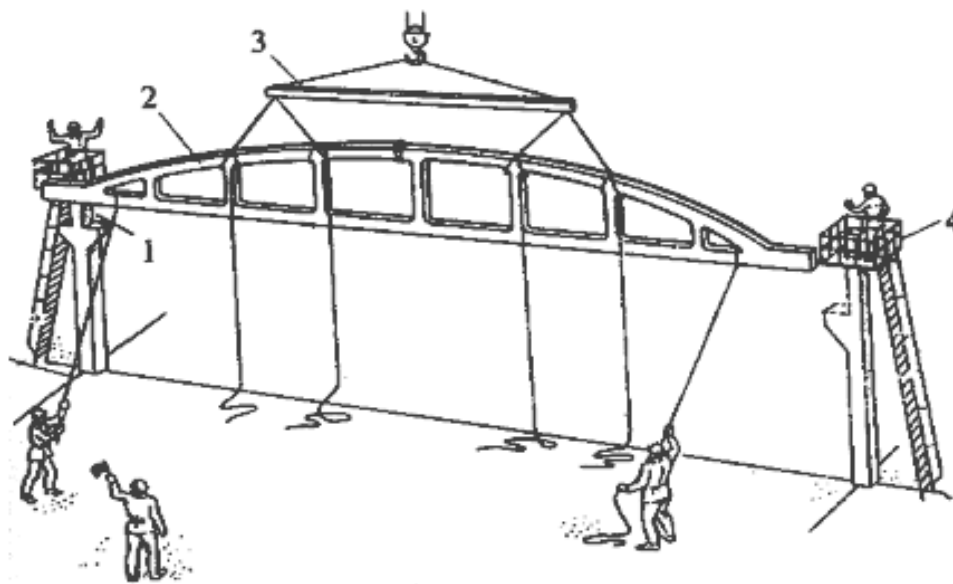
Установка и закрепление фермы на опорах колонны
